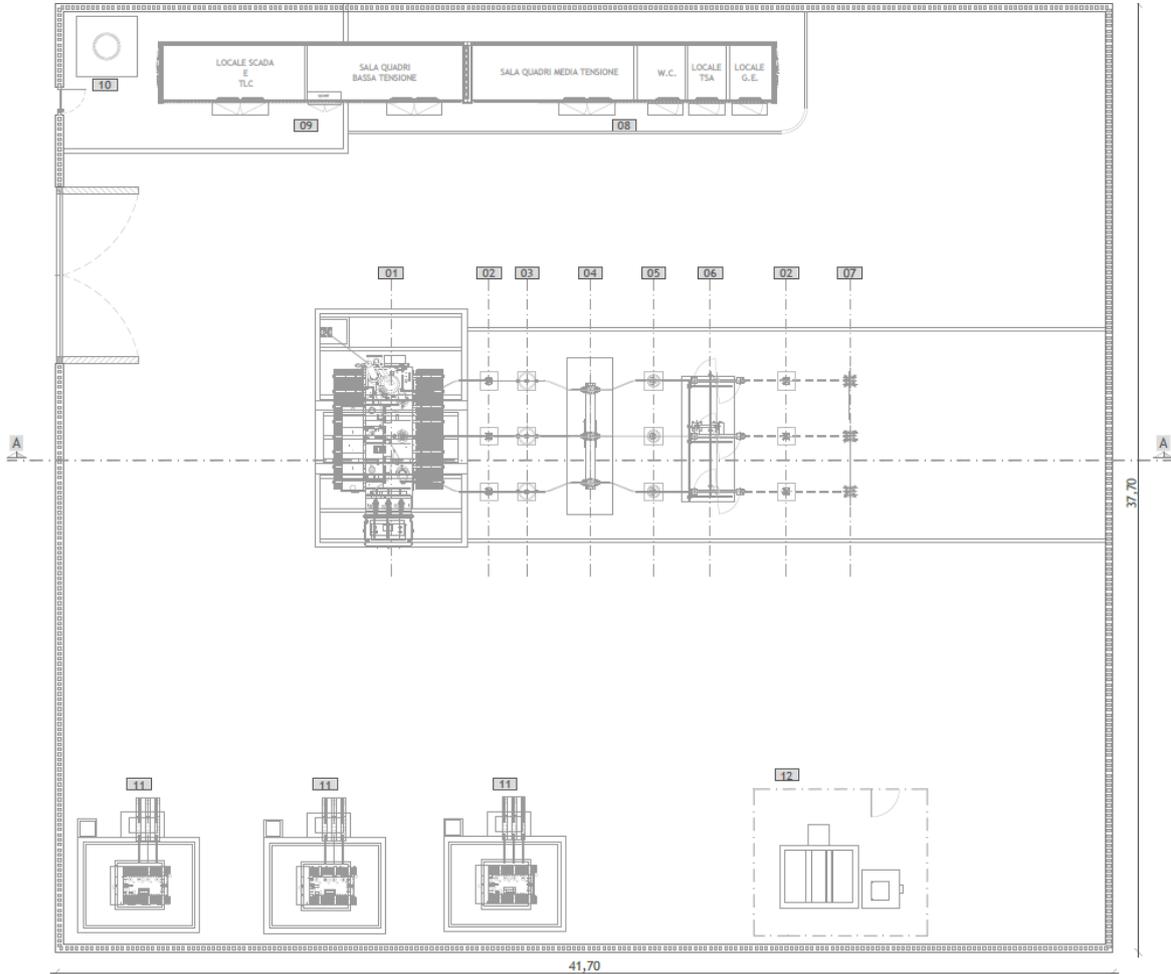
Planimetria elettromeccanica stazione elettrica di utenza
